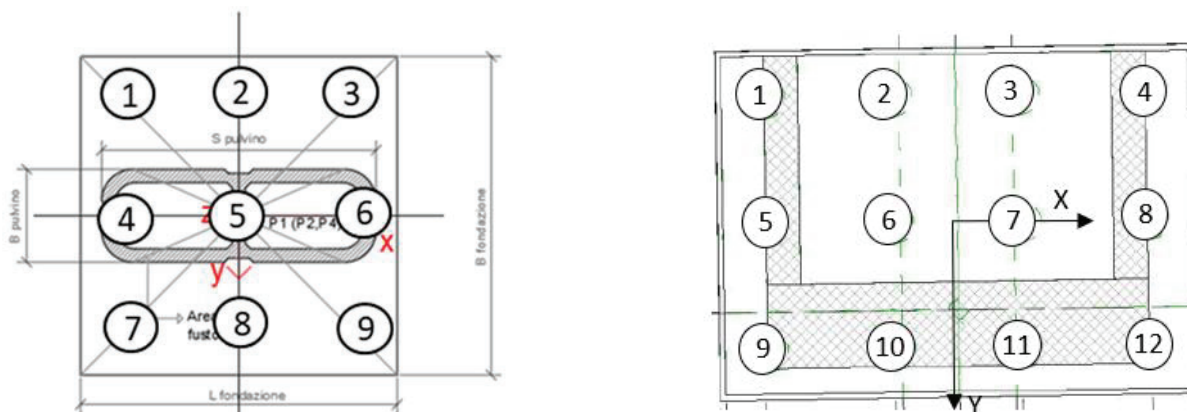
Sistema di riferimento per le fondazioni delle pile e delle spalle con indicazione della numerazione dei pali
